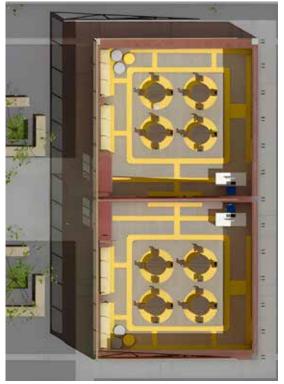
Planta Parque Fuente: Elaboración propia 2023.
